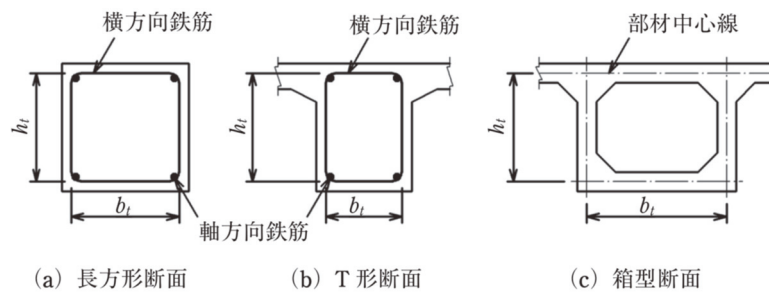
式(5.4.4)に用いる b_t 及び h_t
